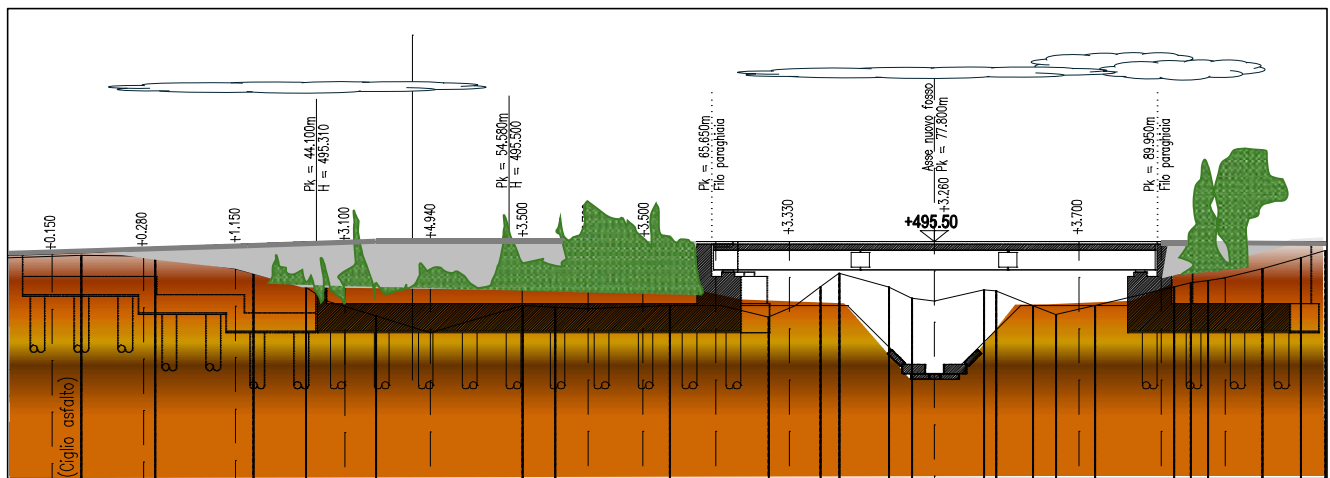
Profilo longitudinale in asse strada – impalcato e spalle laterali
